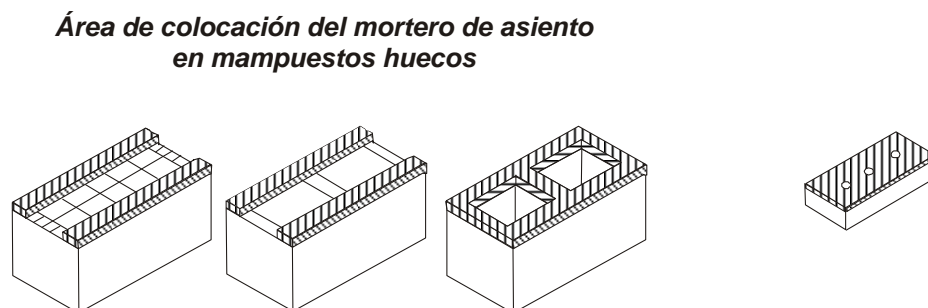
b. Colocación de mortero de asiento en mampuestos.
